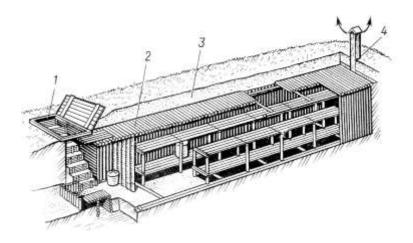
Противорадиационное укрытие из тонких бревен или жердей: 1 — вход в укрытие; 2 — перекрытие из бревен; 3 — грунтовая засыпка; 4 — вытяжная труба.
